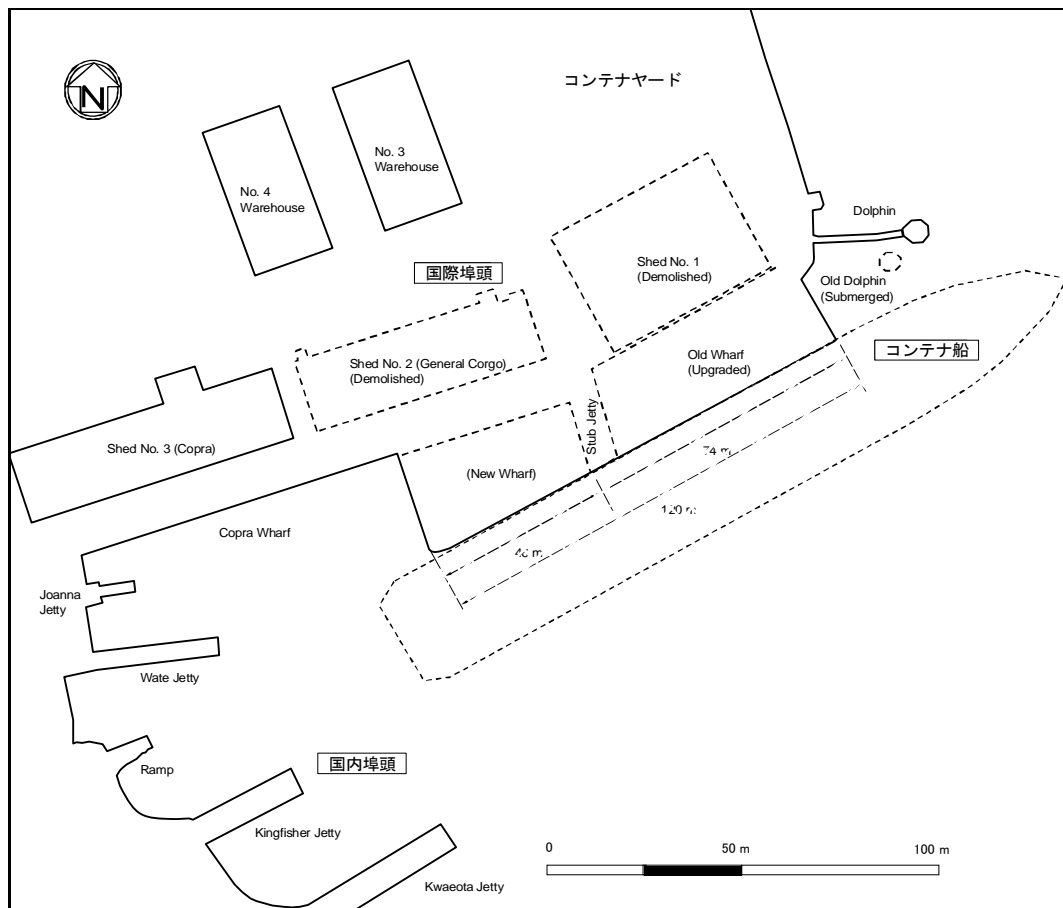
ホニアラ港の国際埠頭の施設配置図
